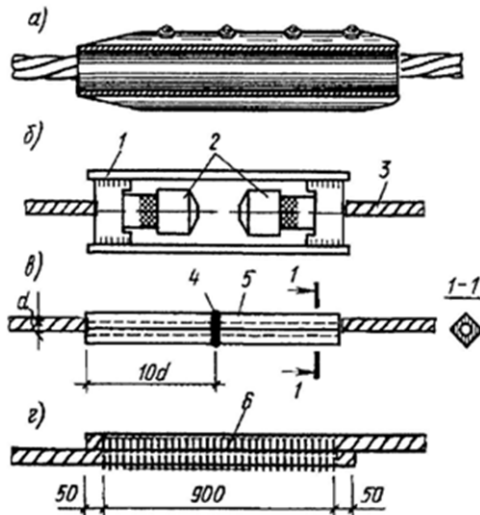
Стыки напрягаемой арматуры: а – посредством обжигаемой обоймы; б – посредством муфт; в – канатов сваркой опрессованных гильз; г – обмоткой вязальной проволокой; 1 – натяжная муфта; 2 – нарезная пробка; 3 – стержневая арматура; 4 – контактная электросварка; 5 – опрессованная гильза; б – вязальная проволока
